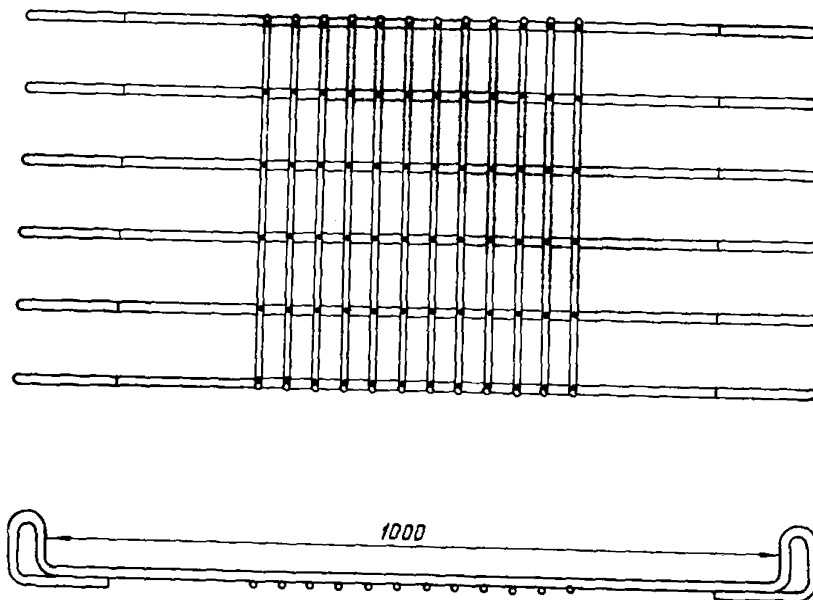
Металлические сварные решетчатые затяжки ЗРЗ
